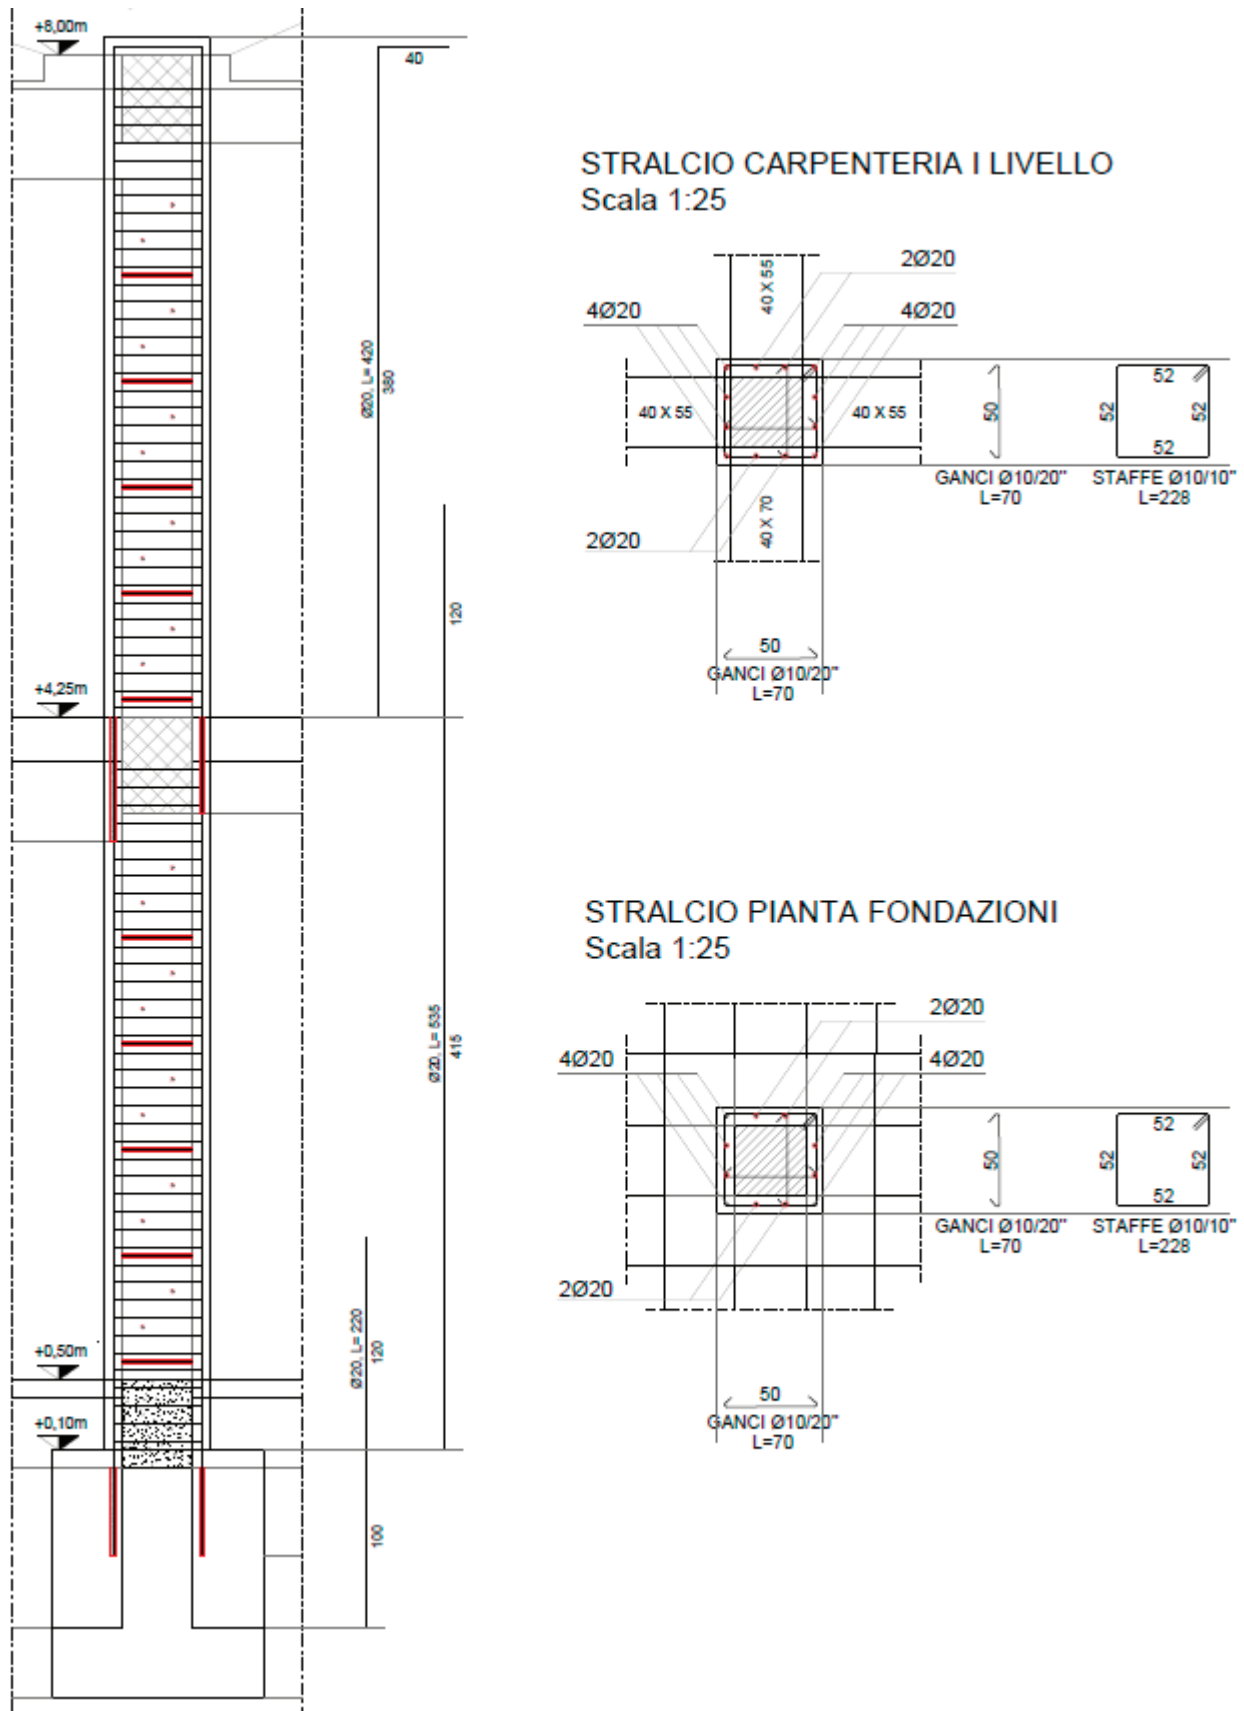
Intervento in elevazione – Ringrosso Pilastri
